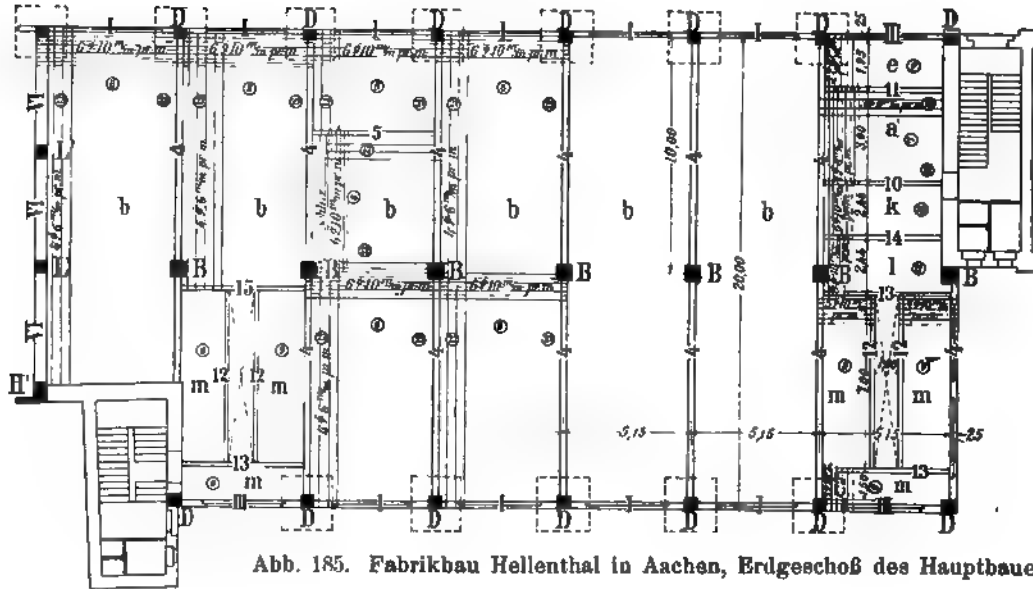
Fabrikbau Hellenthal in Aachen, Erdgeschoß des Hauptbaues.
